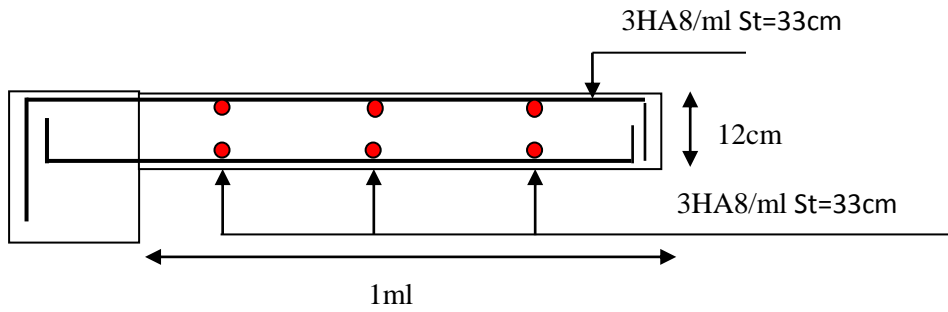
Schéma de ferrailage de la dalle pleine type N° 2.
